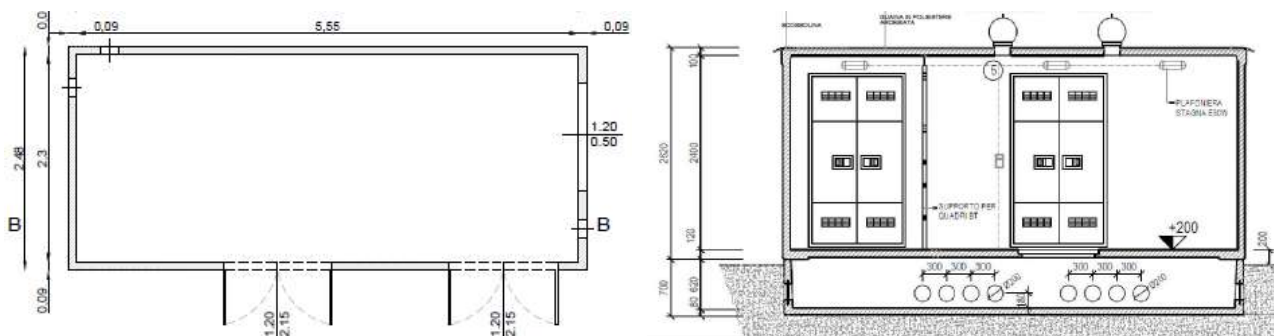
Pianta e prospetto della cabina di sezionamento
